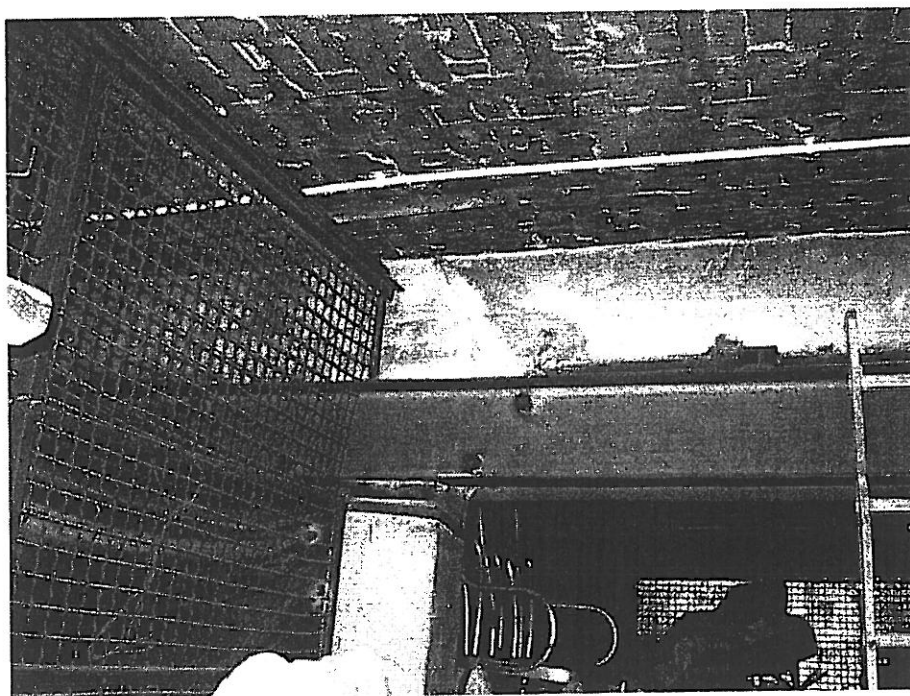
Widoczne zagięcie strzemienia zbrojenia belki poniżej płyty ceramicznej
